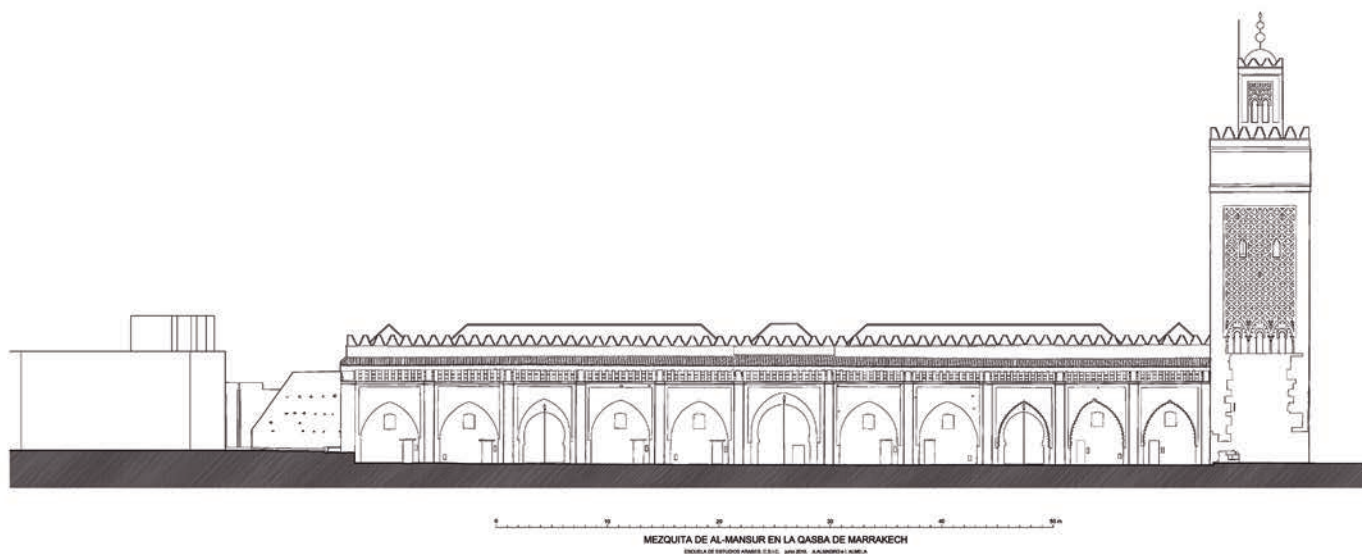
Mezquita de la Qaşba. Alzado septentrional. Plano del autor.
